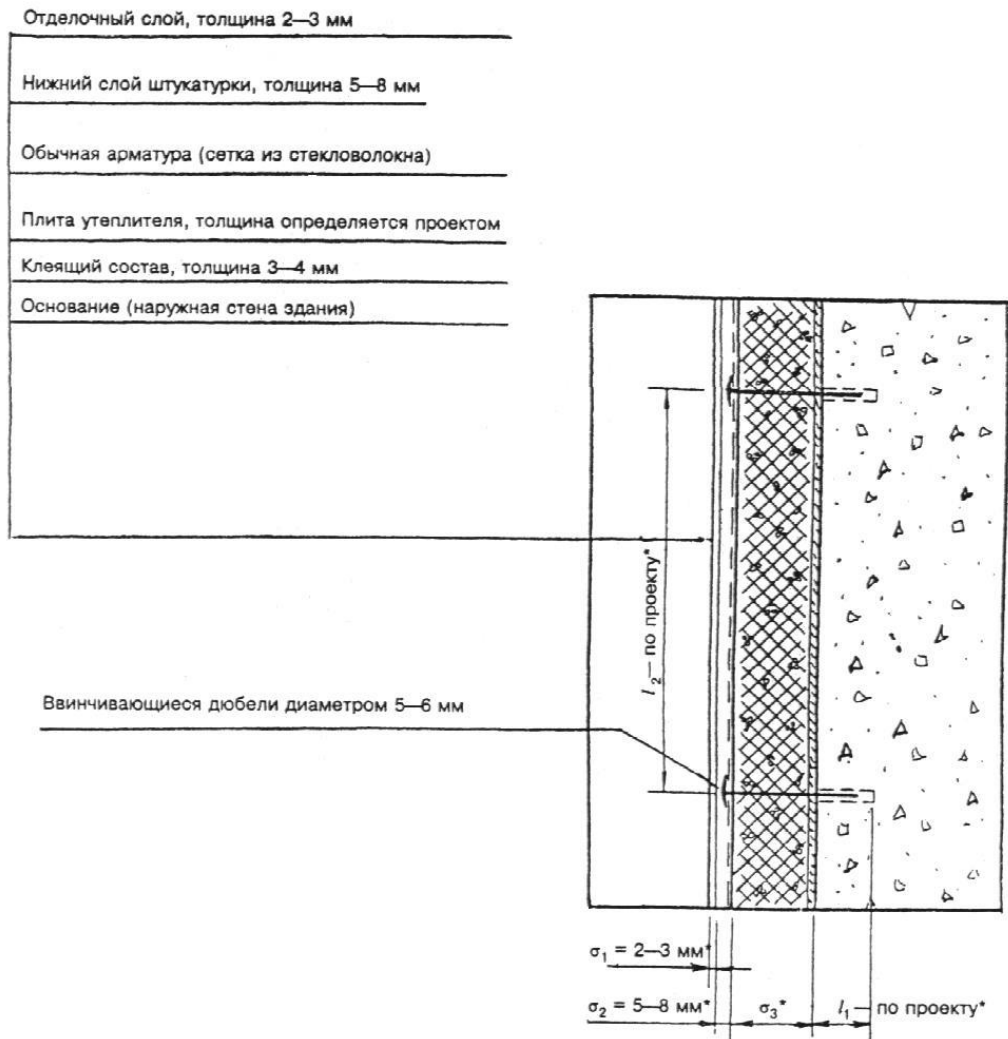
Фрагмент наружной теплоизоляции здания с тонкой штукатуркой по утеплителю
